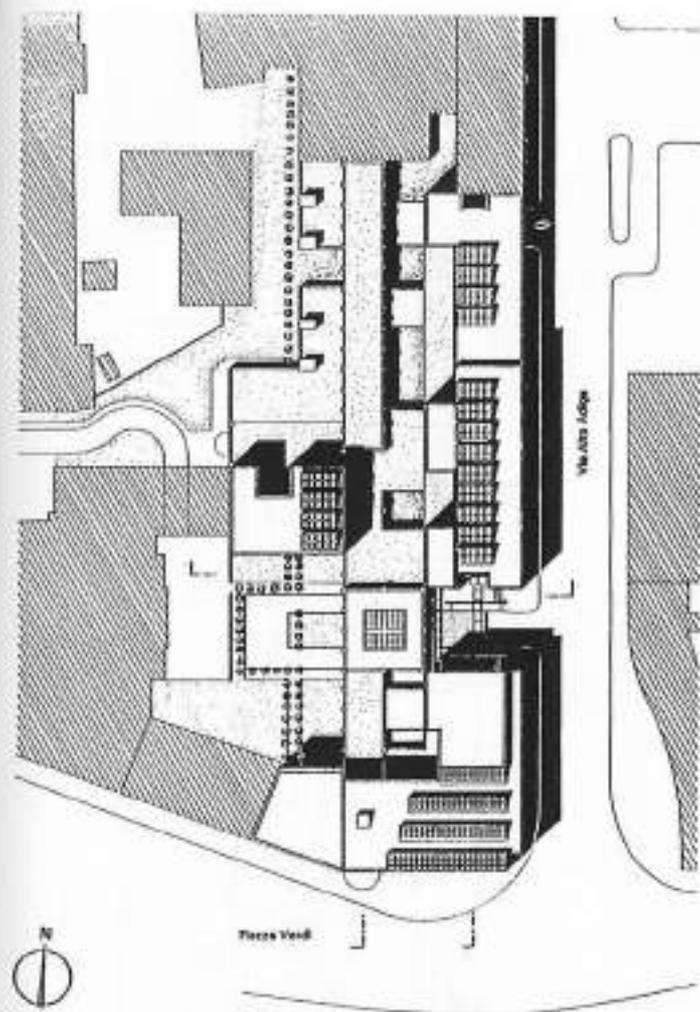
Riqualificazione area Via Alto Adige e piazza Verdi a Bolzano; planimetria generale.
